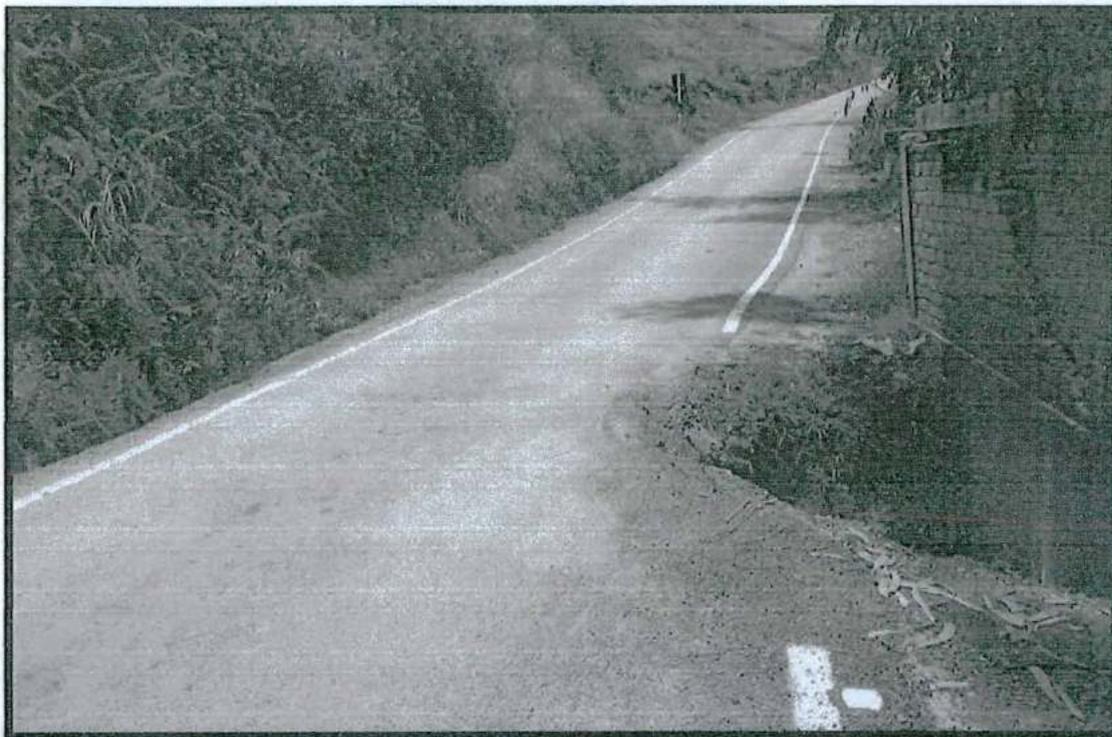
Vista panorámica de la reducción de vía por la alcantarilla existente.
